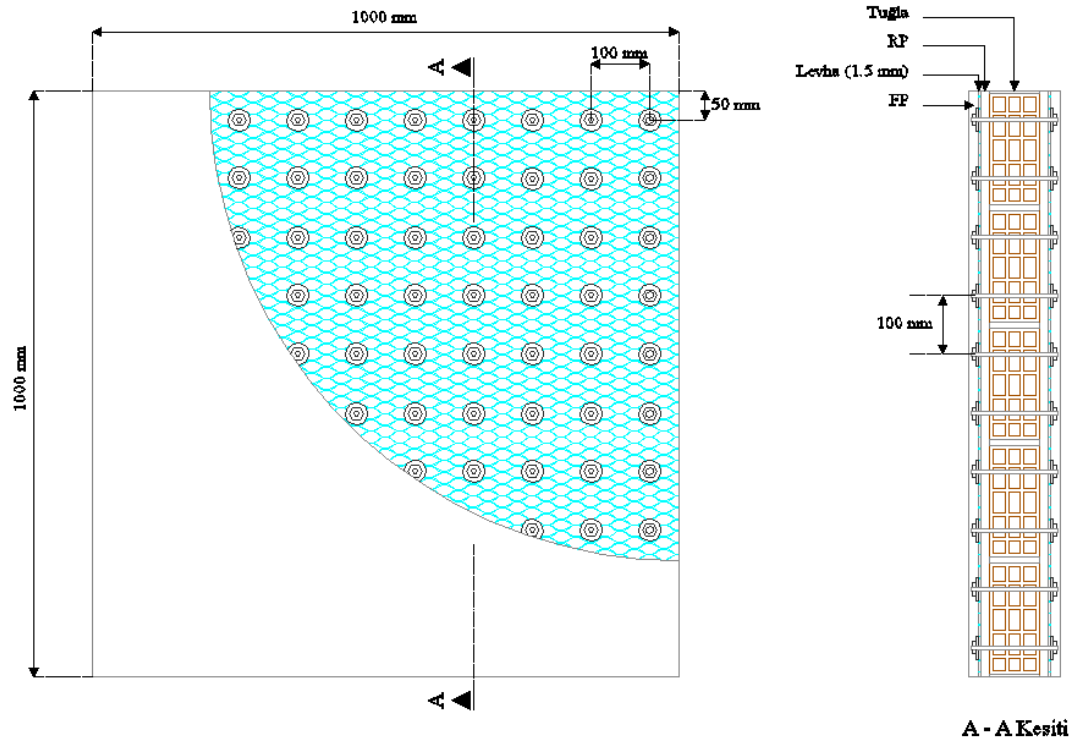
B3,0-100 deney elemanının boyutları ve güçlendirme detayları
